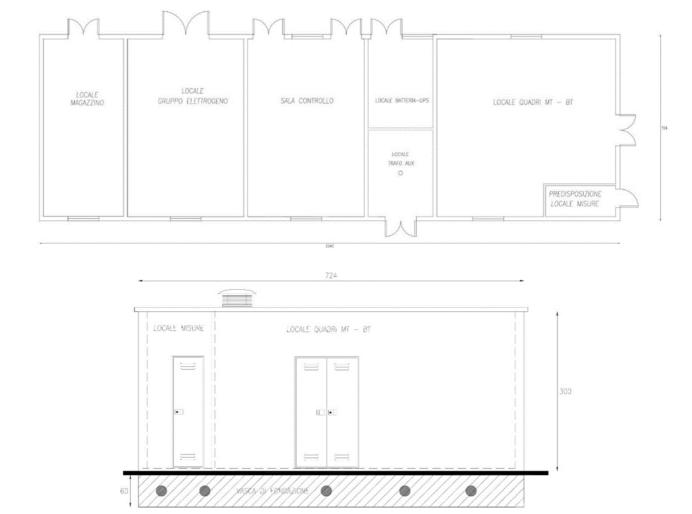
Pianta e Prospetto della Cabina Generale Utente.
